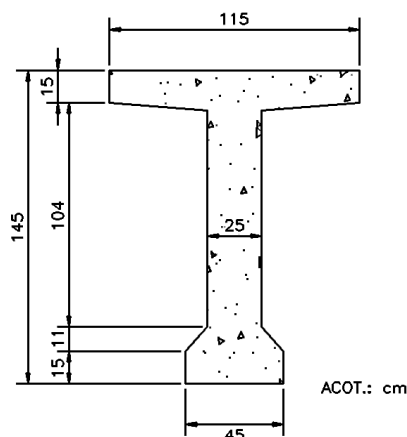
Sección de traves en centímetros que conforman el puente Majahua I
